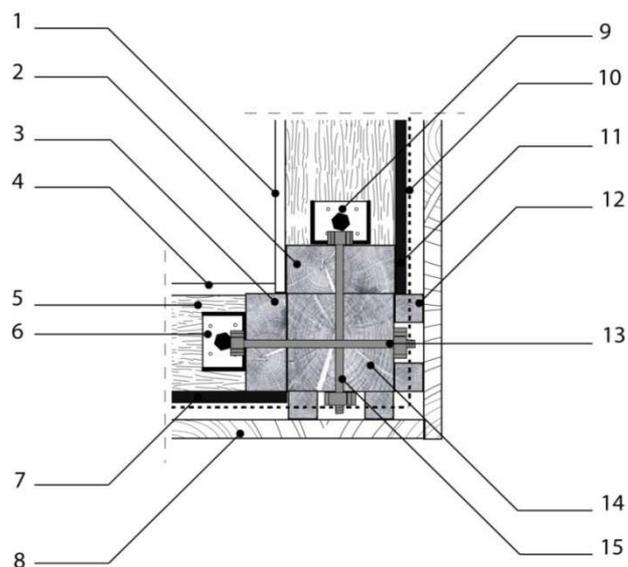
Coupe de principe d'assemblage d'angle sur panneaux murs VT.
